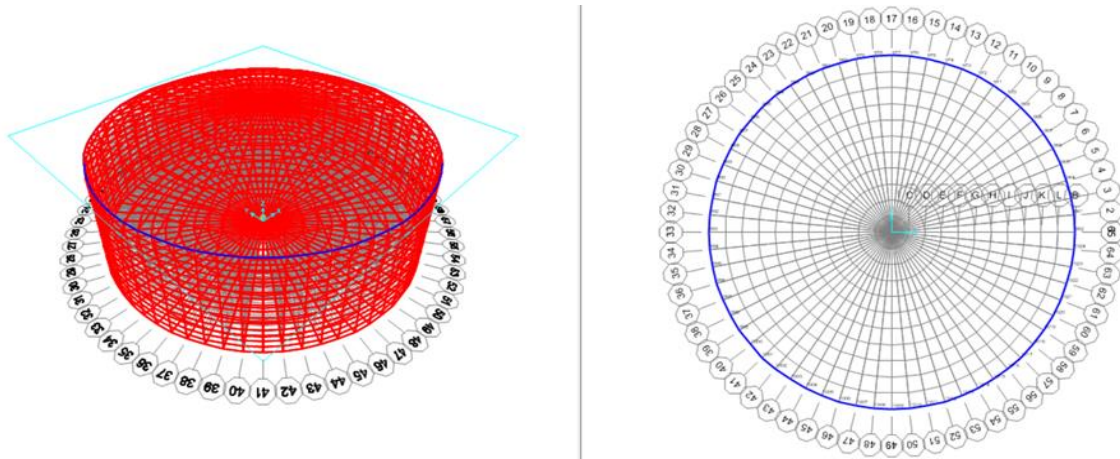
Vista 3D y en planta del modelo del reservorio
